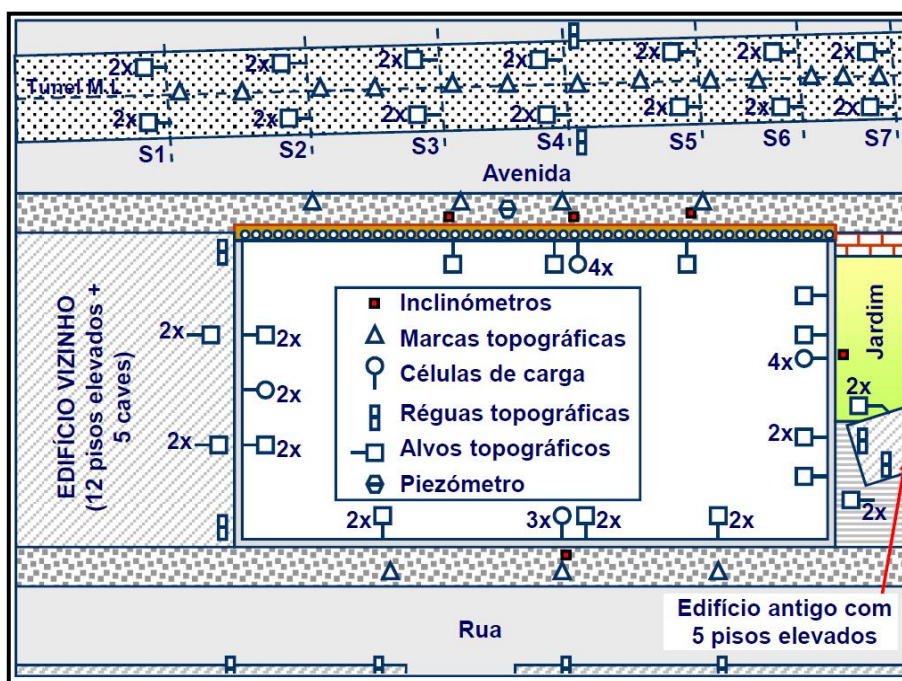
Exemplo e uma planta de instrumentação (Adaptado de Pinto, 2009).
